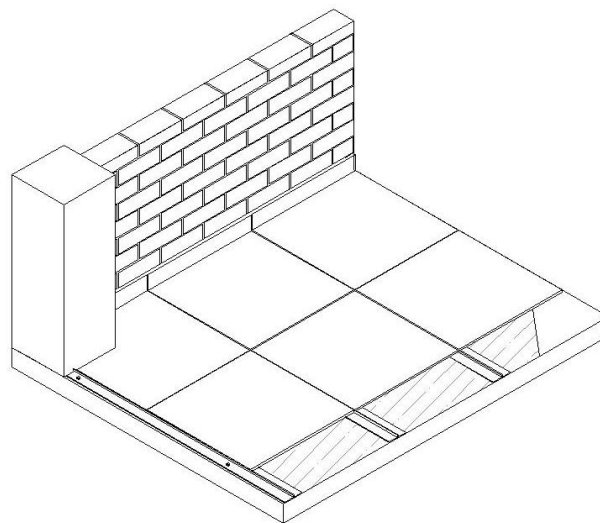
Isométrico detalle Cruce con columna. Elaboración propia.
